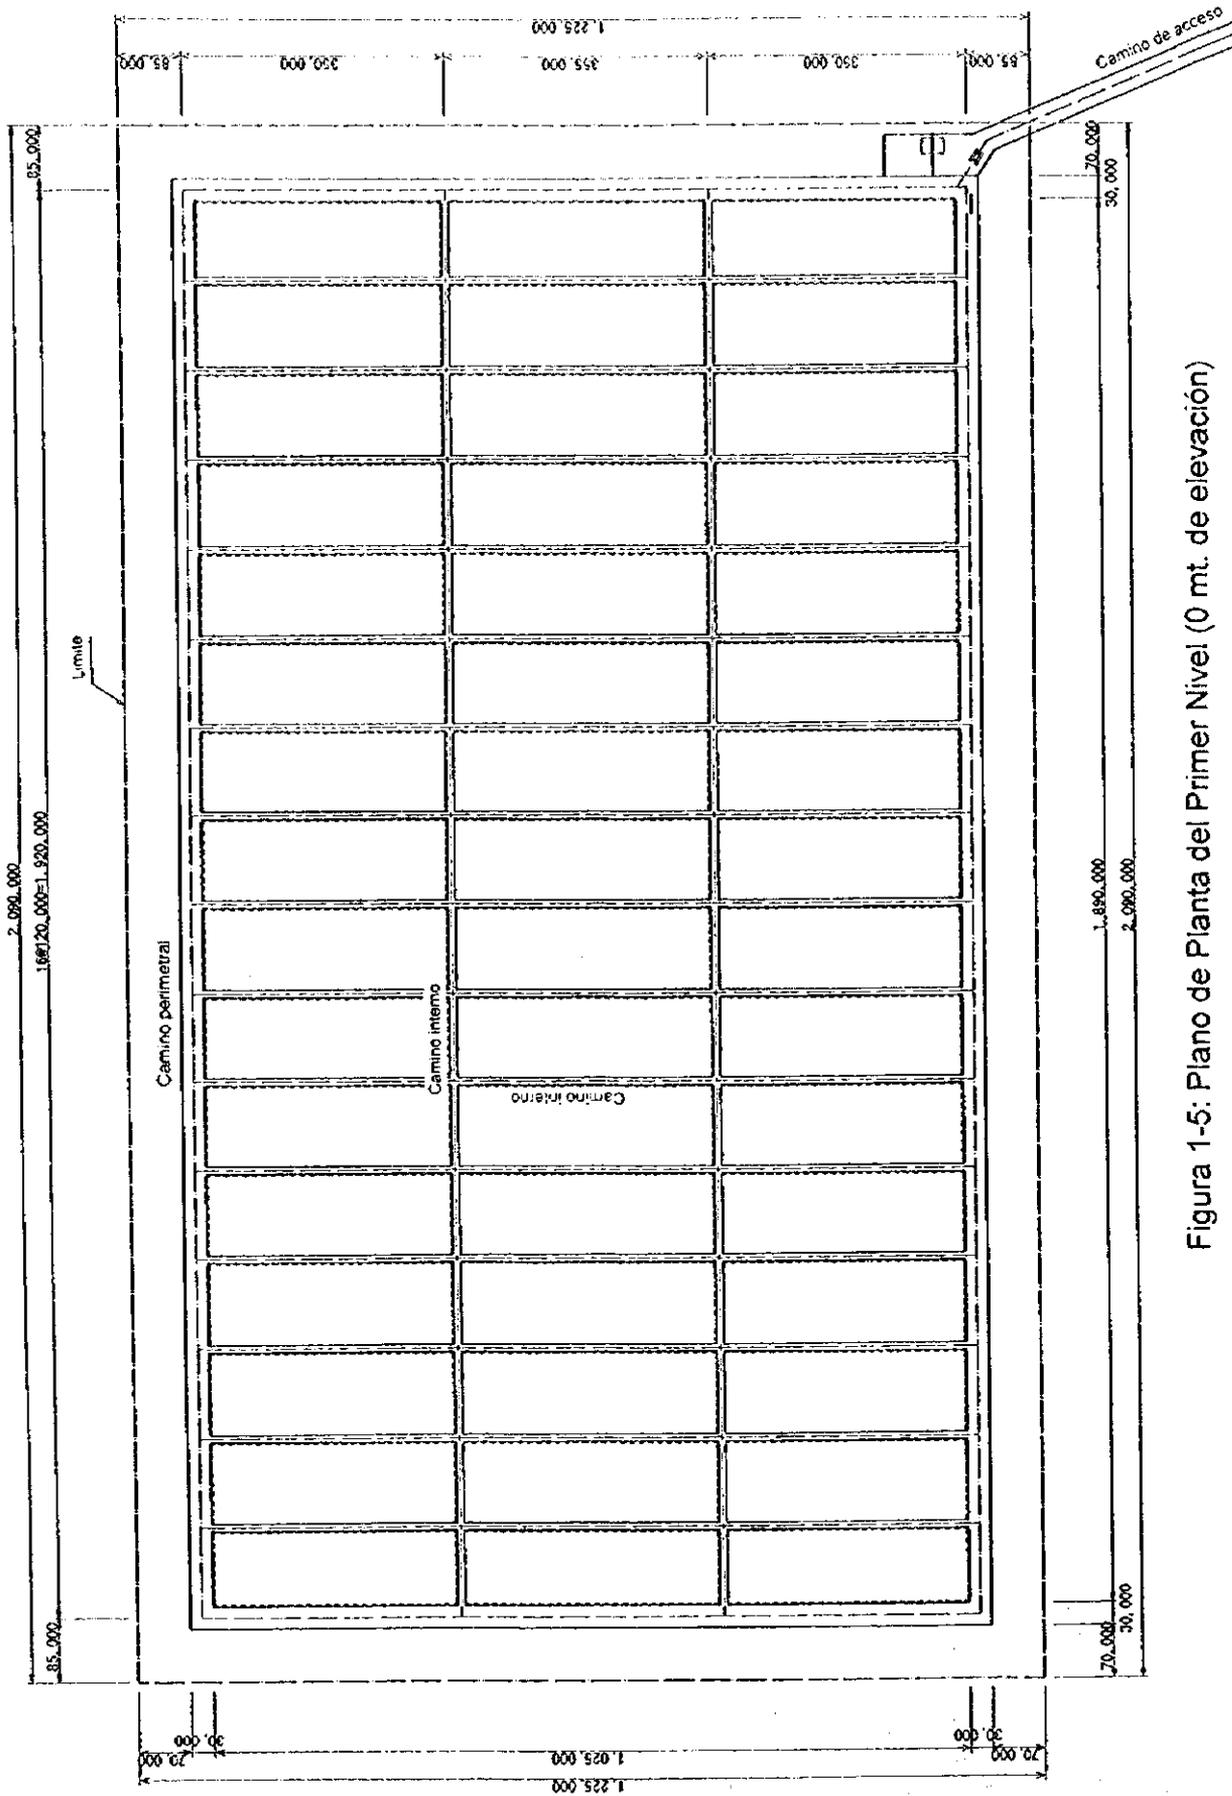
Plano de Planta del Primer Nivel (0 mt. de elevación)
